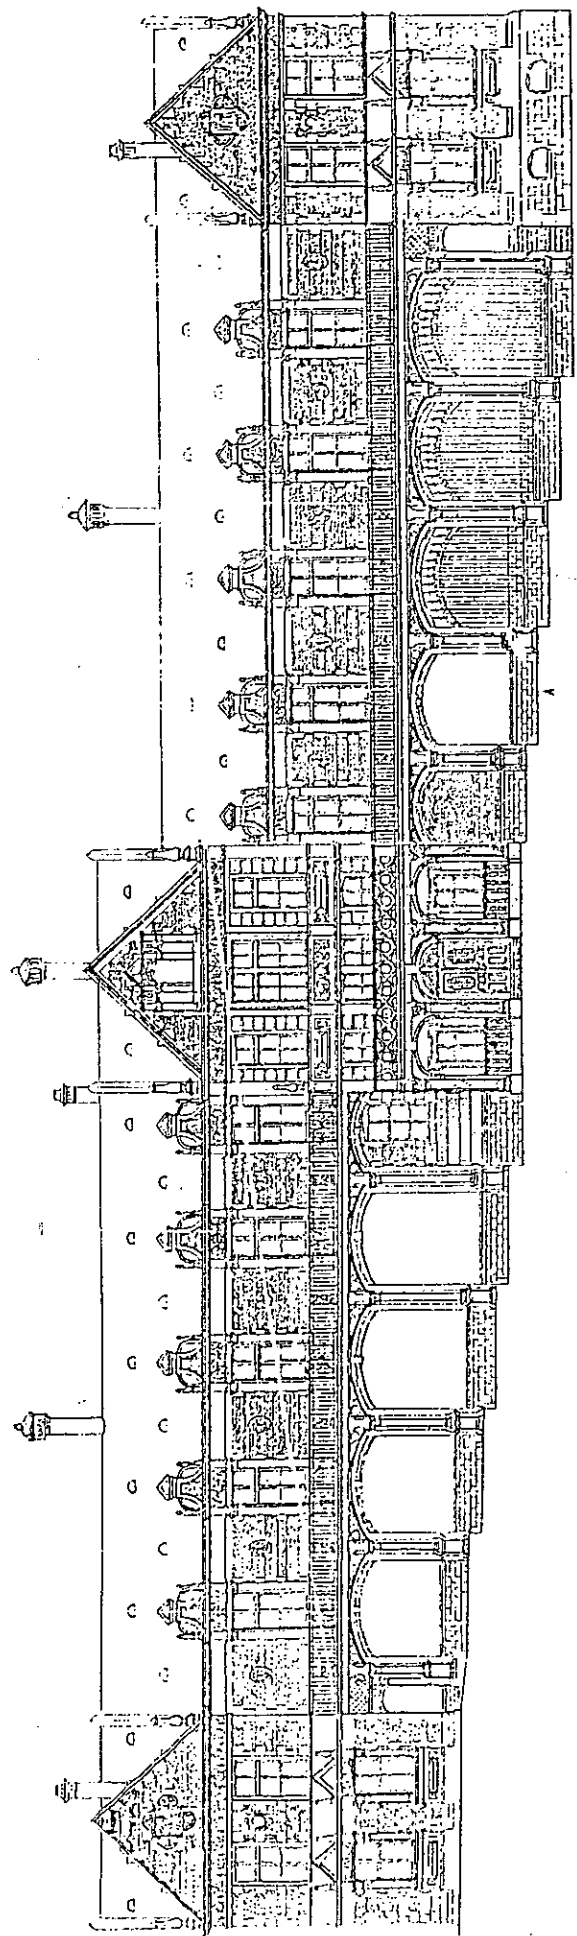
Élévation latérale d'un pavillon de malades, style Renaissance, sur un terrain en forte pente (à éviter).
